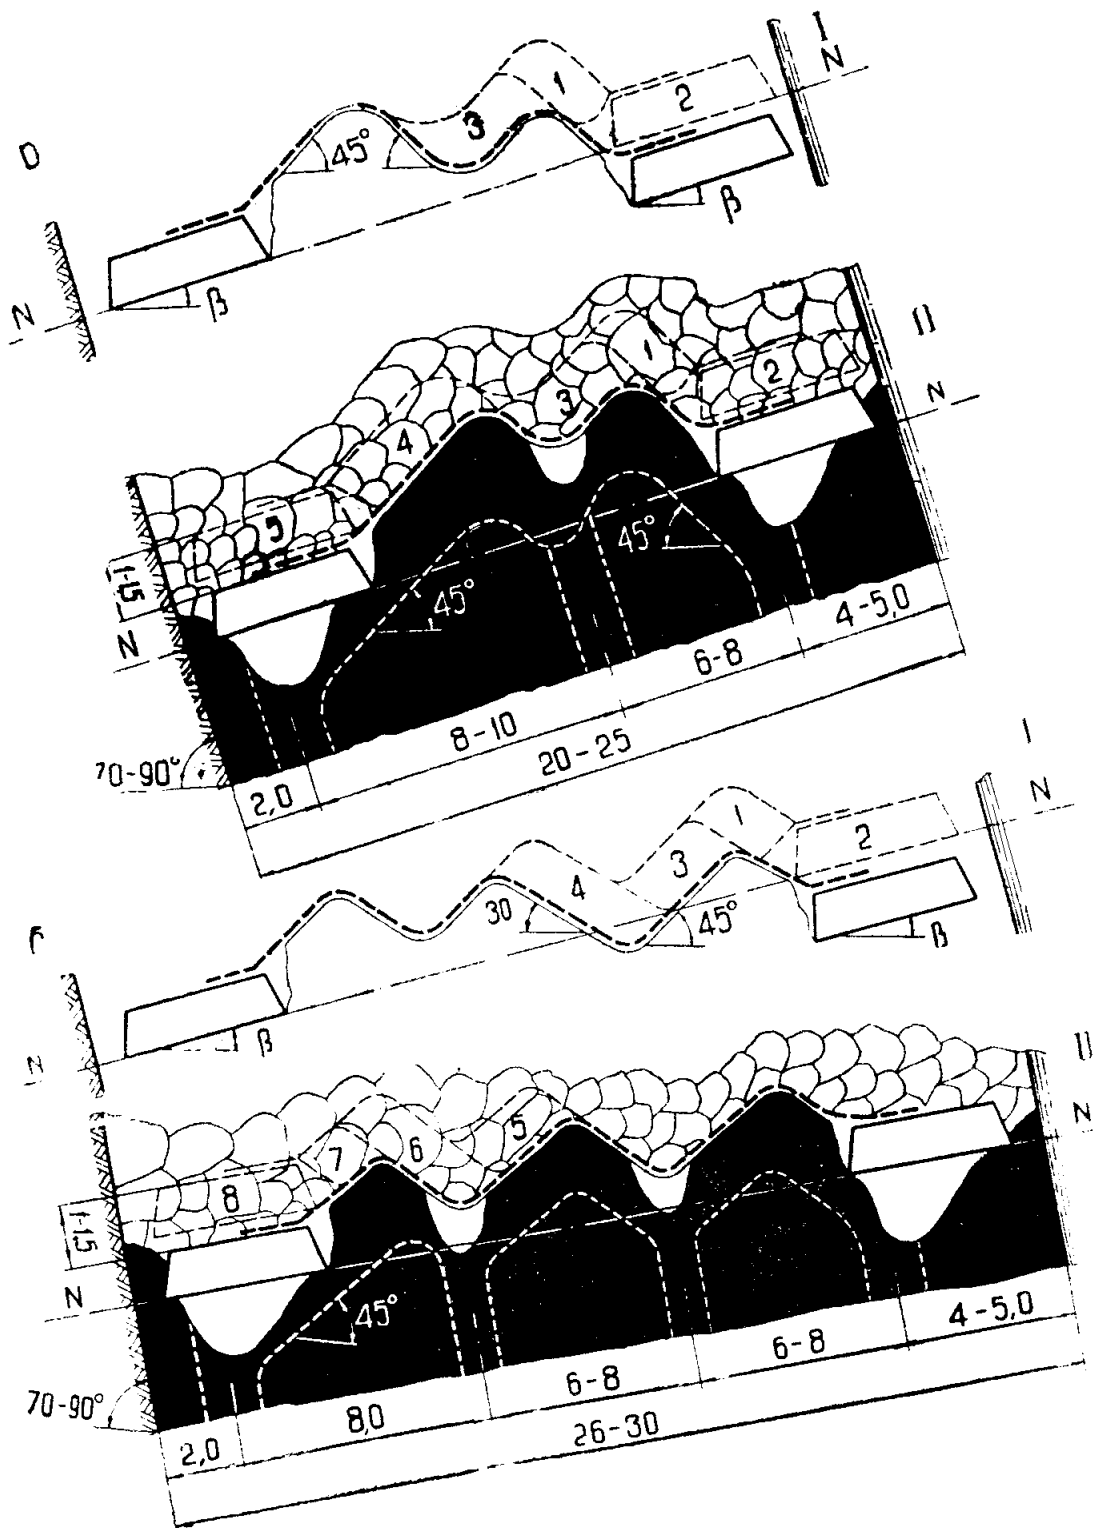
Управление перекрытием в многоскатных забоях при выемке угля в межщитовой толще полосами по простиранию в направлении от кровли к почве пласта; а—четырёхскатный забой; б—шестискатный забой.
